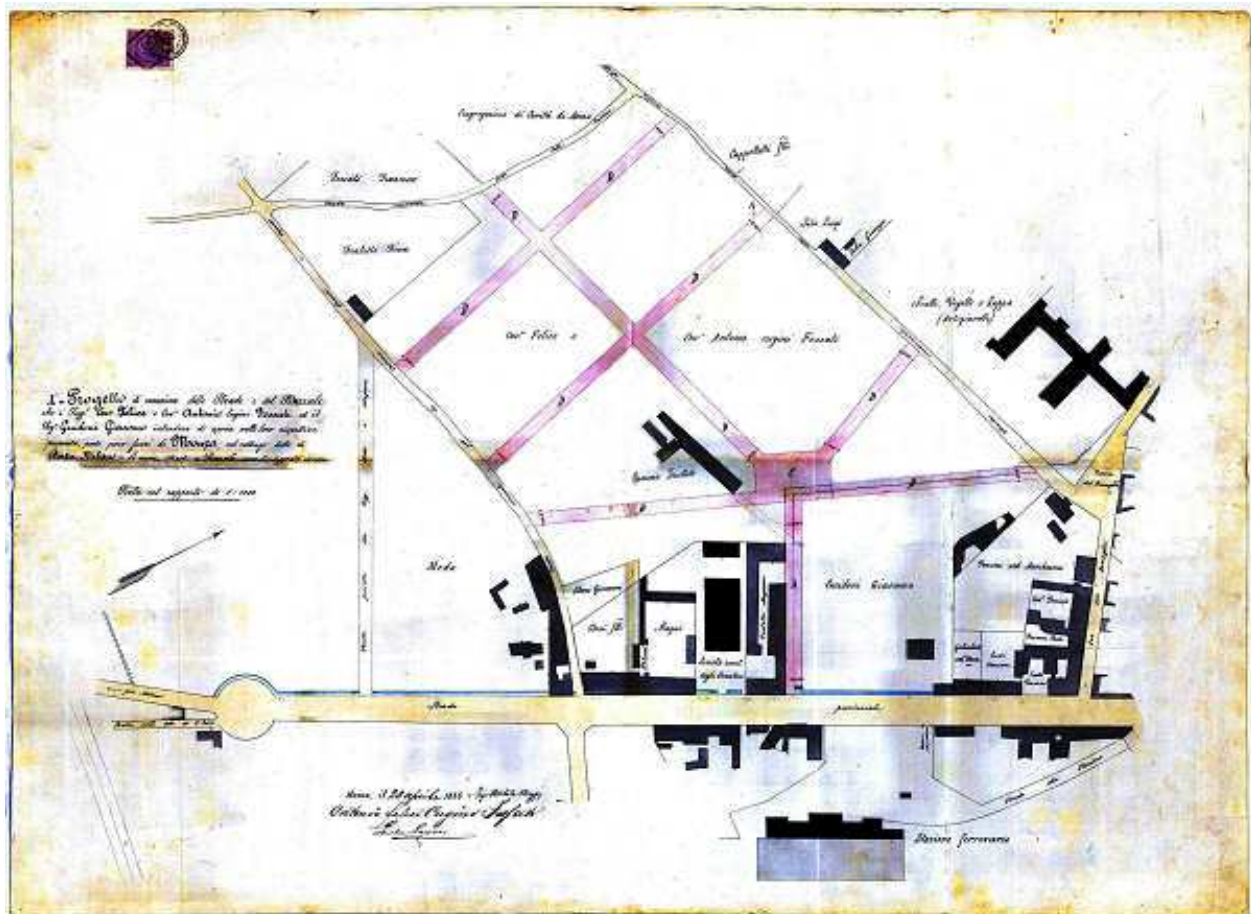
MONZA – PROGETTO DELLE STRADE DEL PIAZZAALE DI PORTA MILANO DEL 1889
